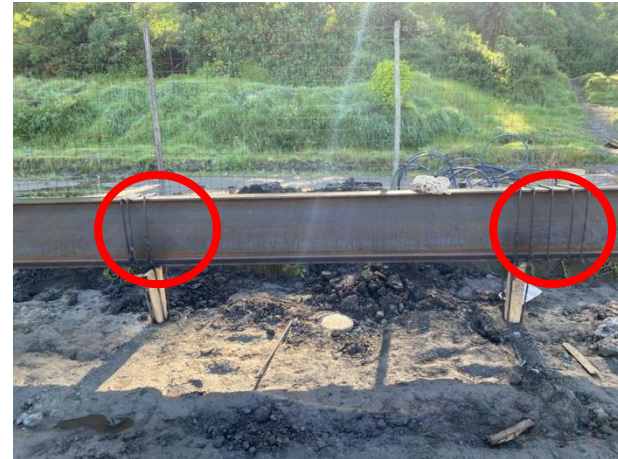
Soldadura de la viga metálica con ayuda de retroexcavadora.
